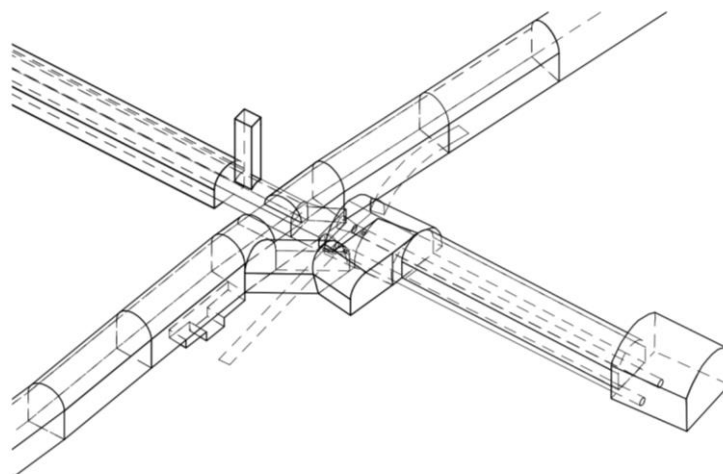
Vista 3D della galleria trasversale dello scarico di fondo, della galleria longitudinale di drenaggio e ispezione e delle camere di manovra
